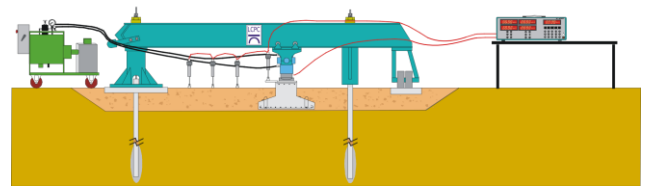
Station foraine d'essais de fondations superficielles des Laboratoires des Ponts et Chaussées
